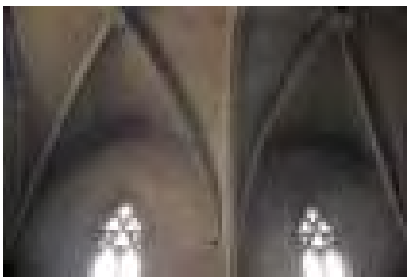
Bóvedas del primer y segundo tramos del transepto norte, hacia el este. Se aprecia la separación entre los plementos, arcos formeros y muro de cierre
